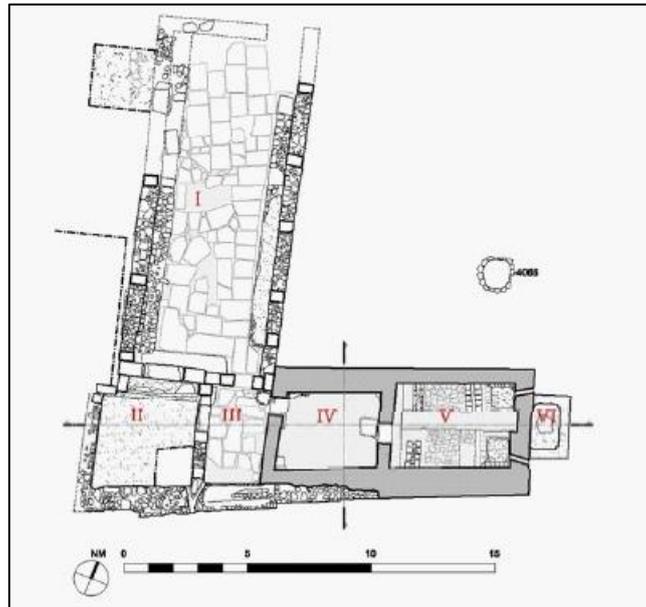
Plan du hammam de Walila. Source EL HABASHI²⁸⁰
